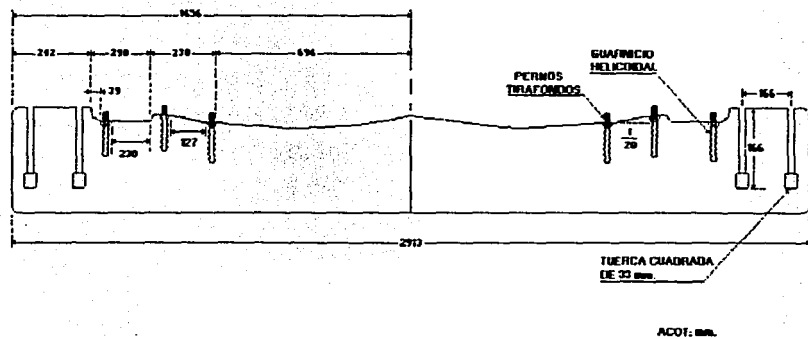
DURMIENTE MONOBLOCK DE CONCRETO
